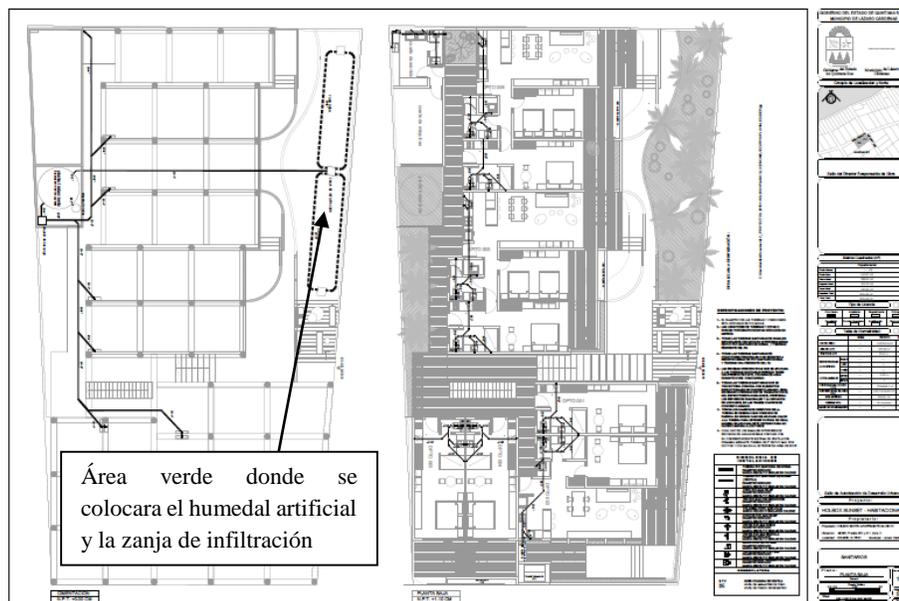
Ubicación de la zanja de infiltración del proyecto.
